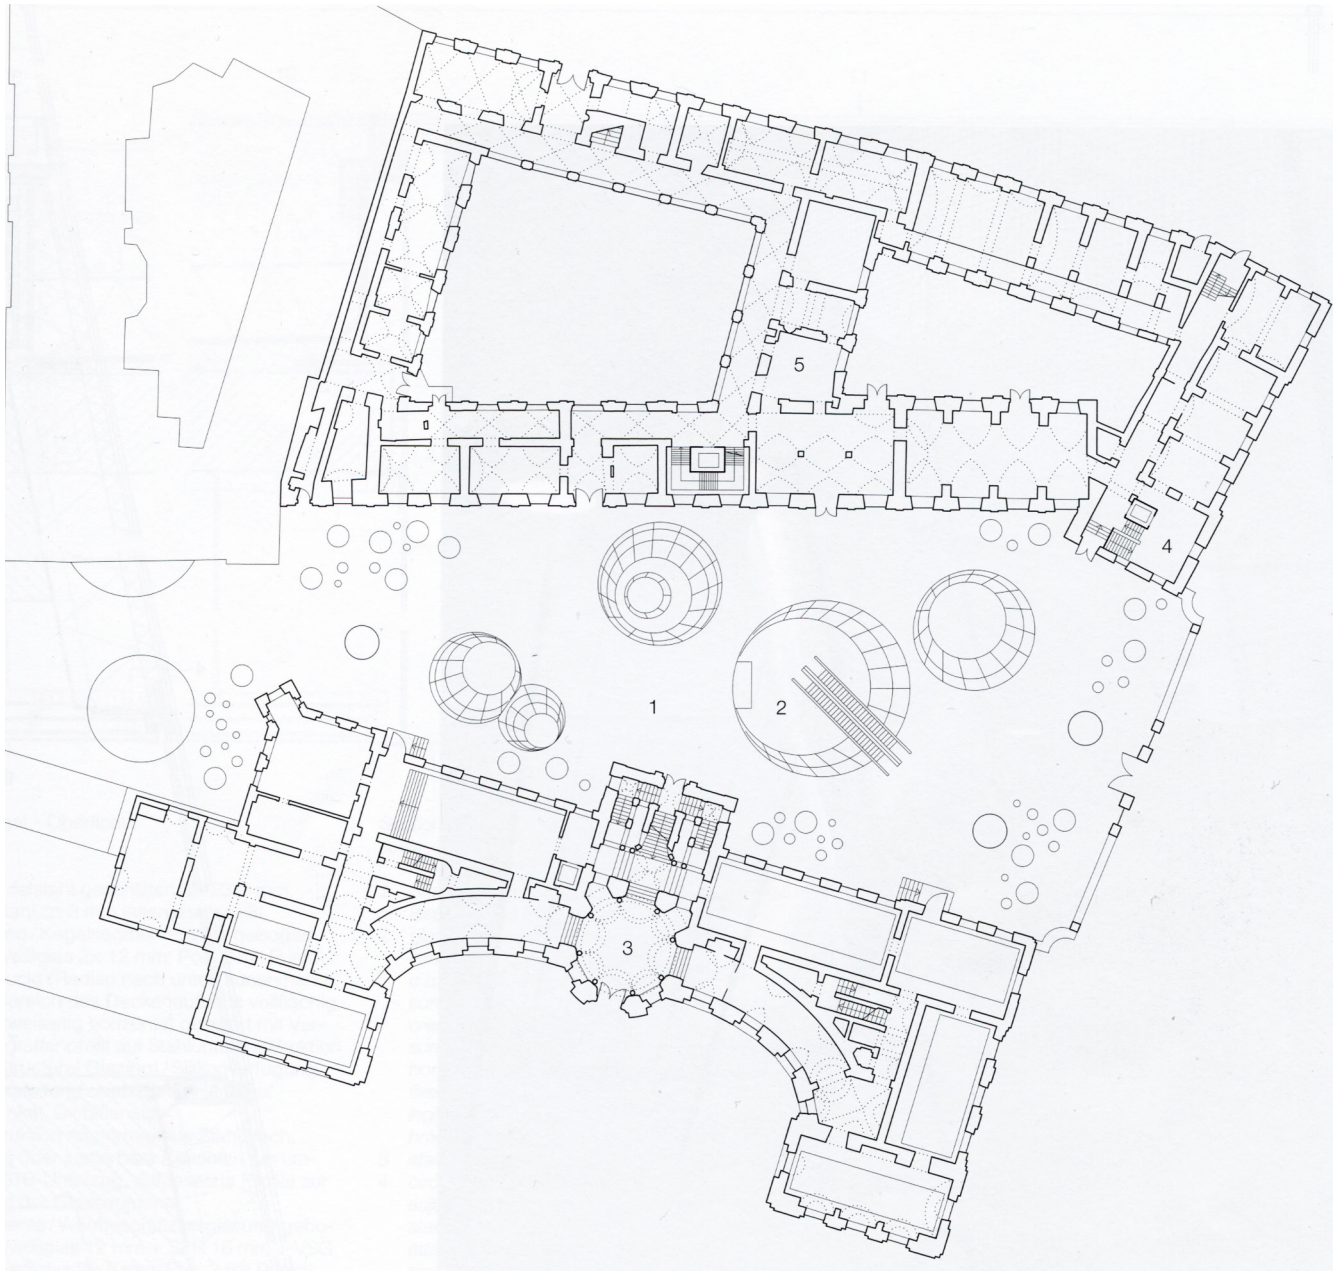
Grundriss EG Besucherzentrum Joanneum
